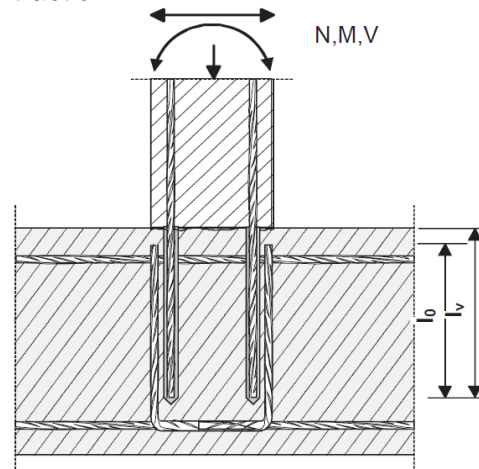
Ancrage en extrémités de dalles ou poutres en appui simple
